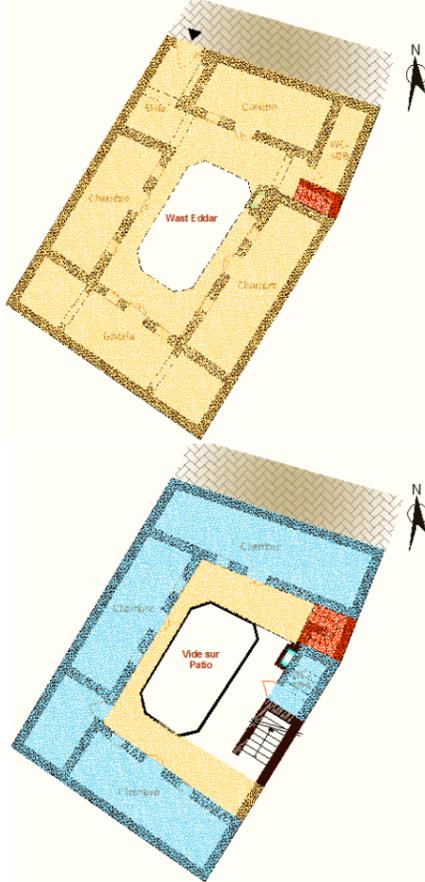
Plan du rez de chaussée de Dar Hssayen– Ouled Imam-
